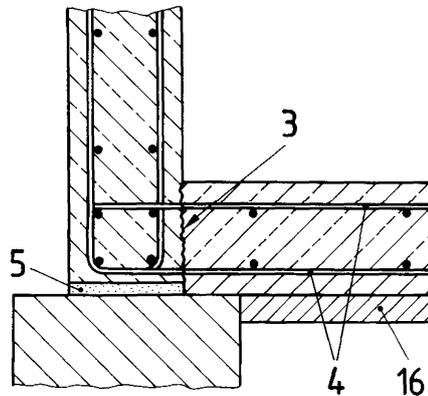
Behälterwand aus Stahlbetonfertigteilen, Stahlbetonsohle nachträglich betoniert
